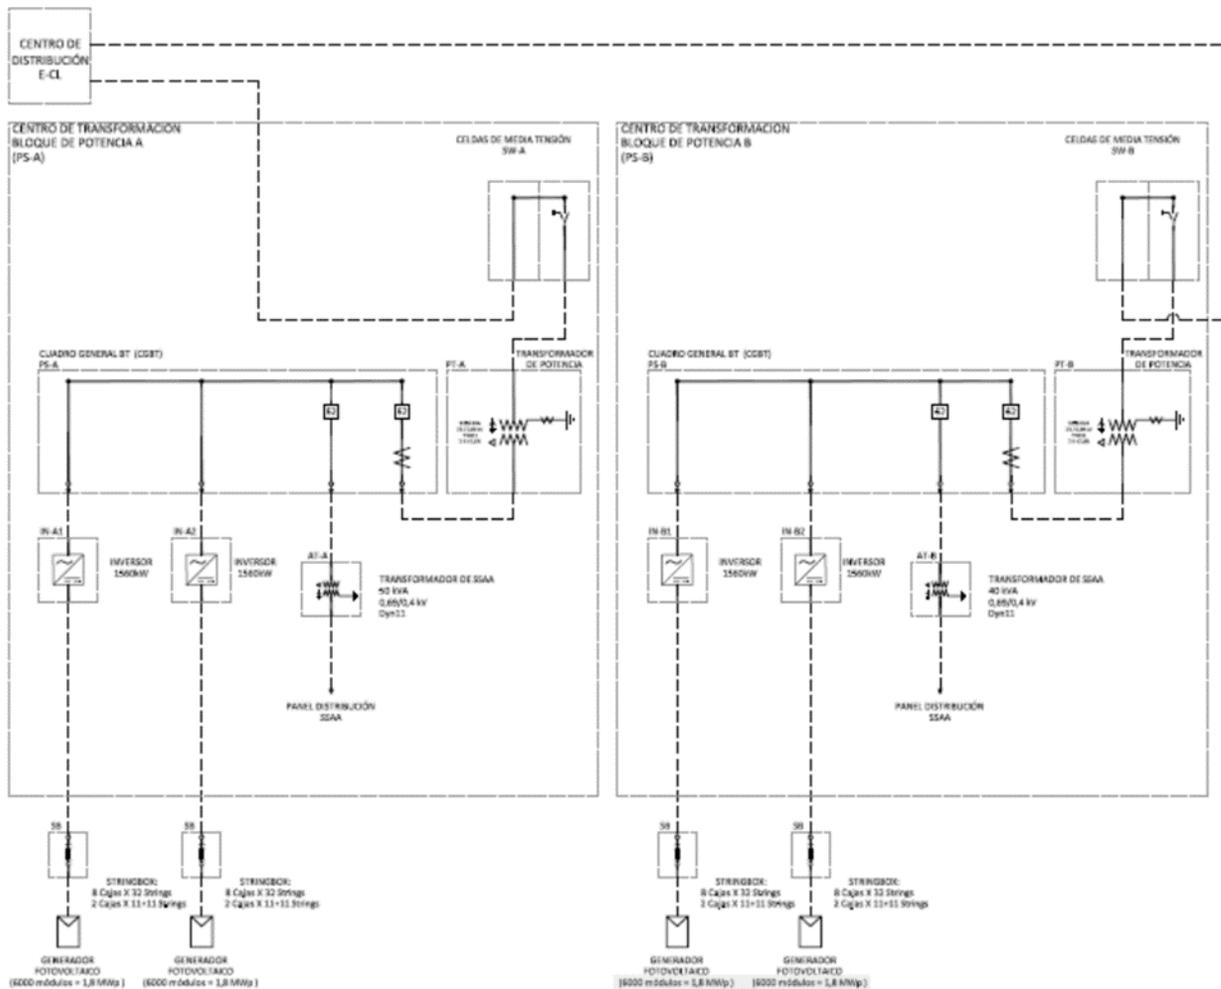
Plano unifilar de la Planta Solar Pampa Camarones
